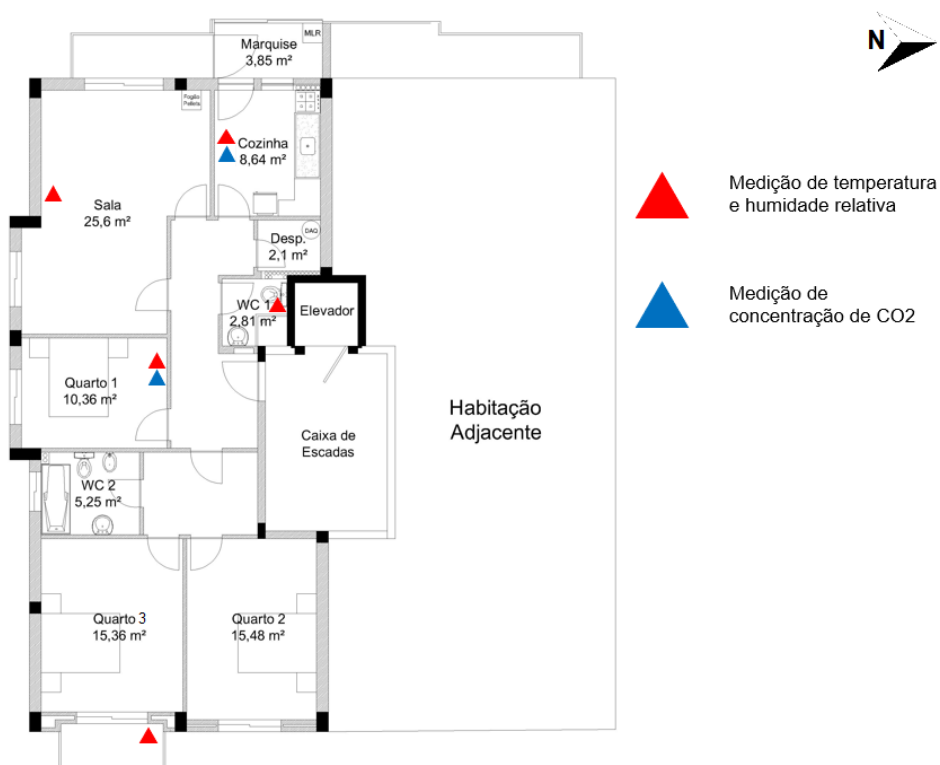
Planta da habitação em estudo e respetivas zonas de monitorização
